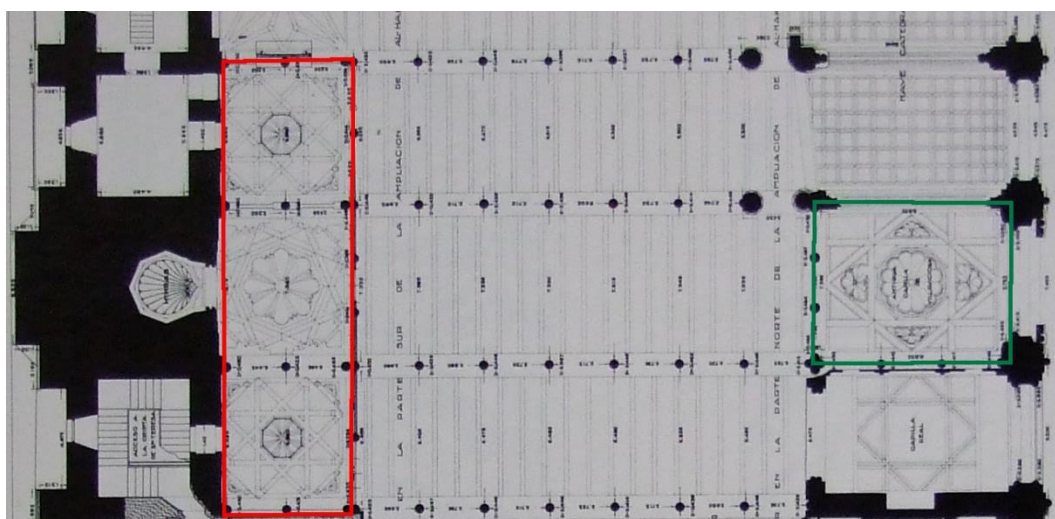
Plano del arquitecto Félix Hernández, Hoja 3 de la Mezquita-Catedral de Córdoba, 1930 (Nieto Cumplido y Luca de Tena y Alvea 1992).
